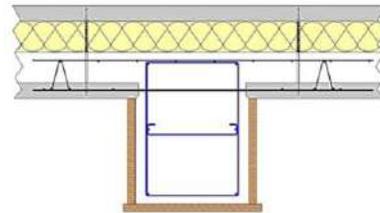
Poteau intégré au « Duomur Isolant » avec coffrage d'une face sur chantier
